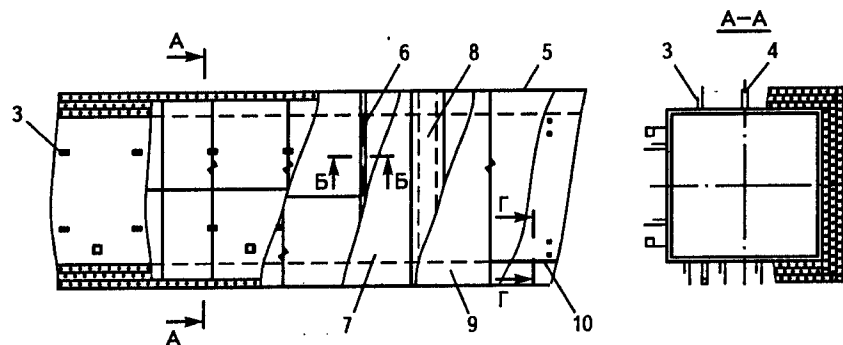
Конструкция тепловой изоляции на основе матов и плит минераловатных для воздухопроводов приточной вентиляции прямоугольного сечения:
